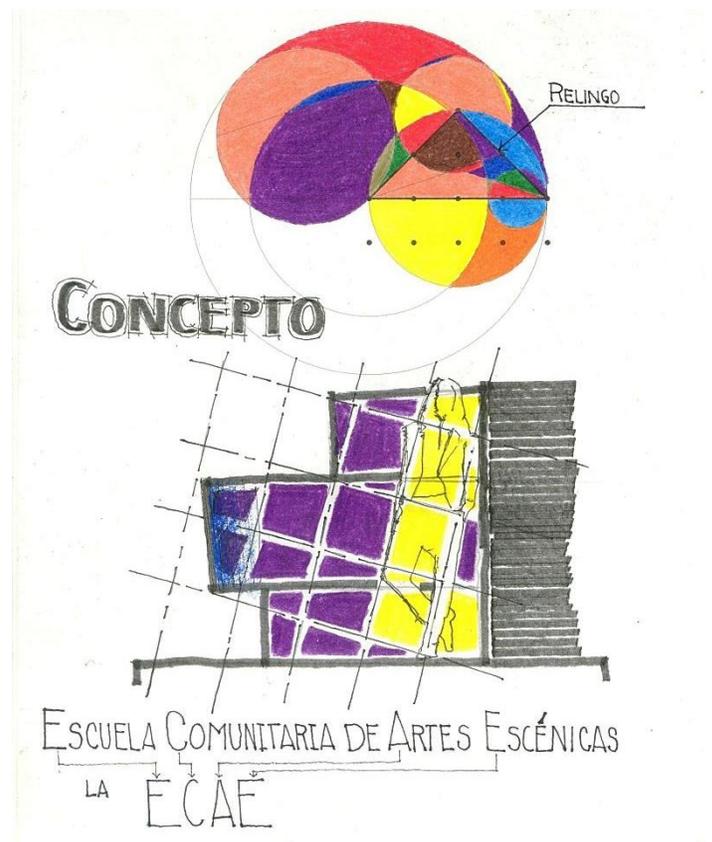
Fundamentos del Concepto Arquitectónico. Croquis que rigen la fachada. Proyecto ESCAE. Elaboración propia
